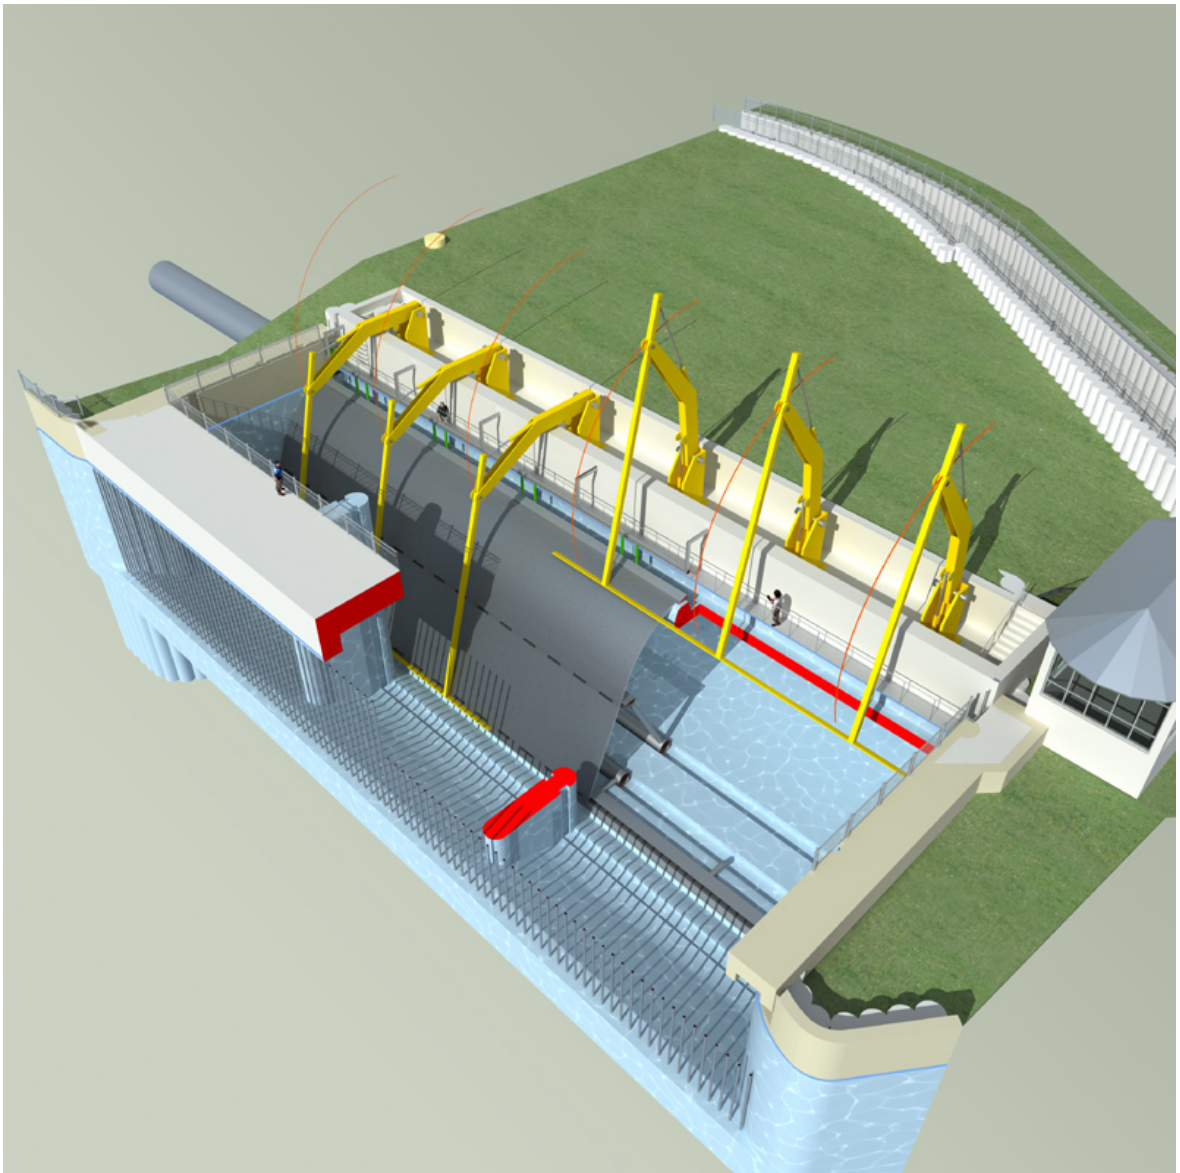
Einlauf des Weserkraftwerks Bremens mit den Einrichtungen zum Fischschutz und zur Fischwanderung
